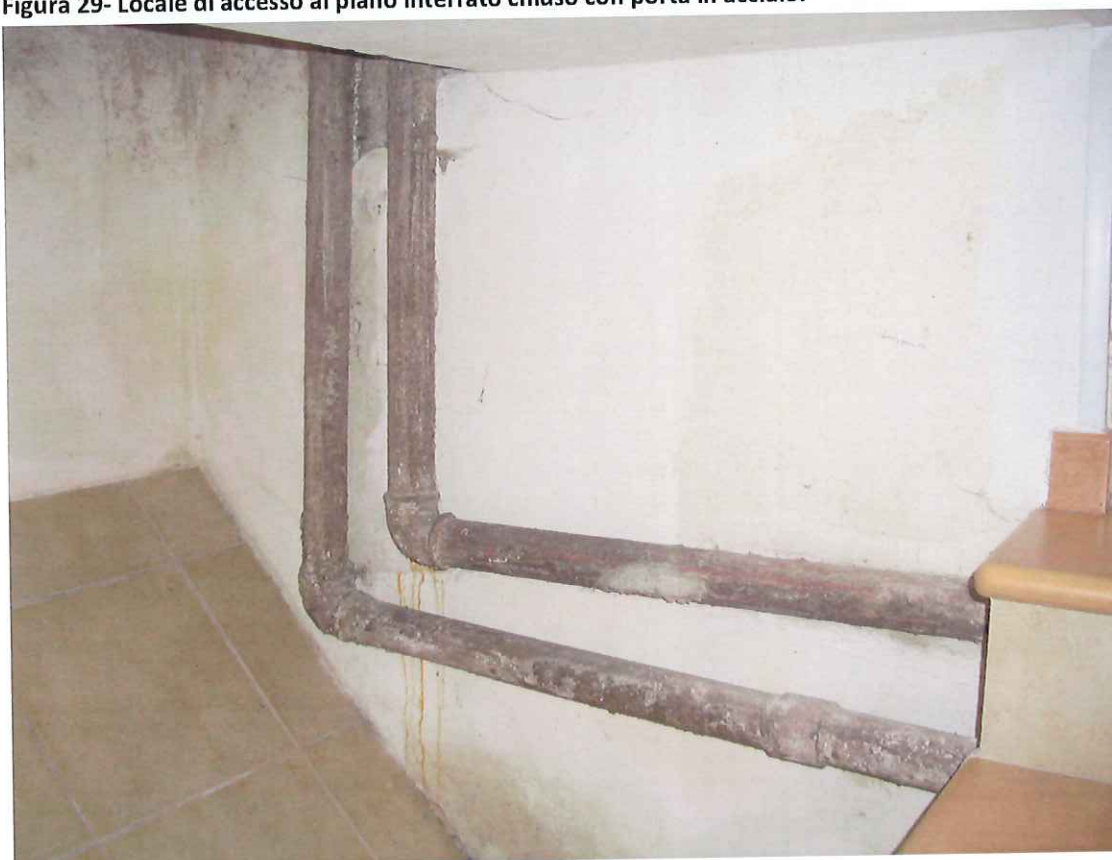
Tubazioni condominiali acquedotto che attraversano il piano interrato ex deposito.
